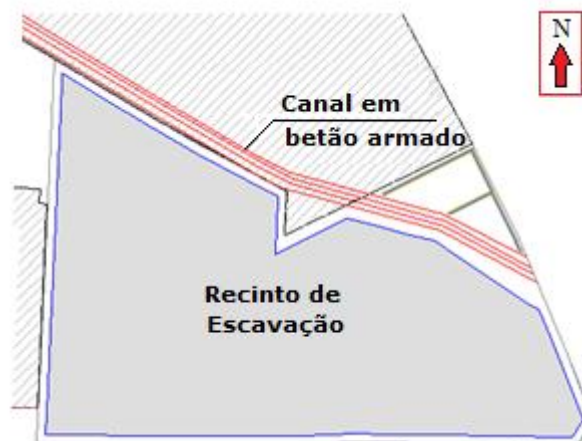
Canal enterrado em betão armado localizado ao longo de um dos alçados da obra
